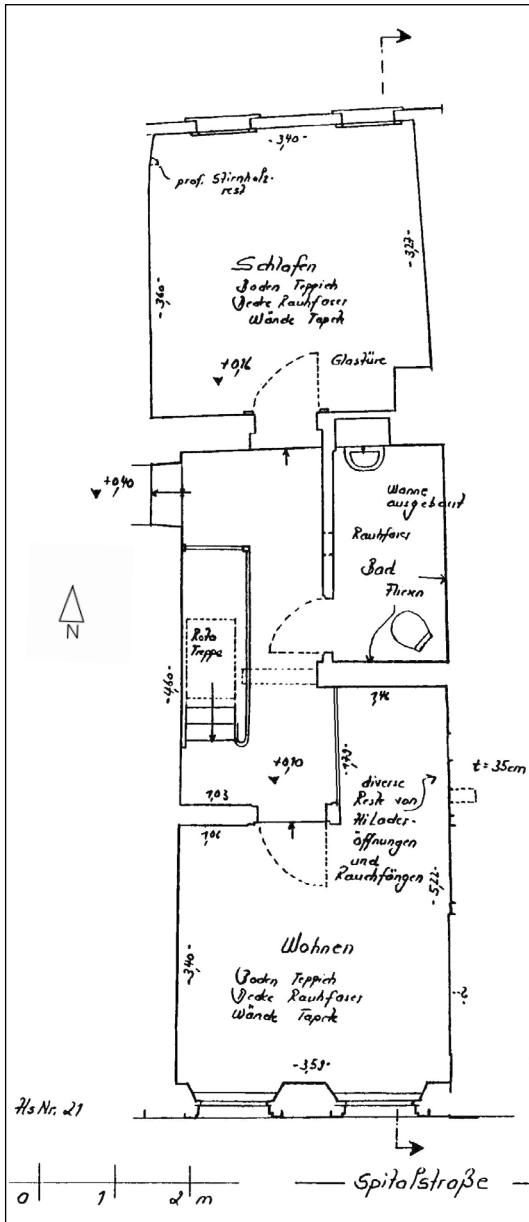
Spitalstraße 23, Grundriss 1. Obergeschoss.
